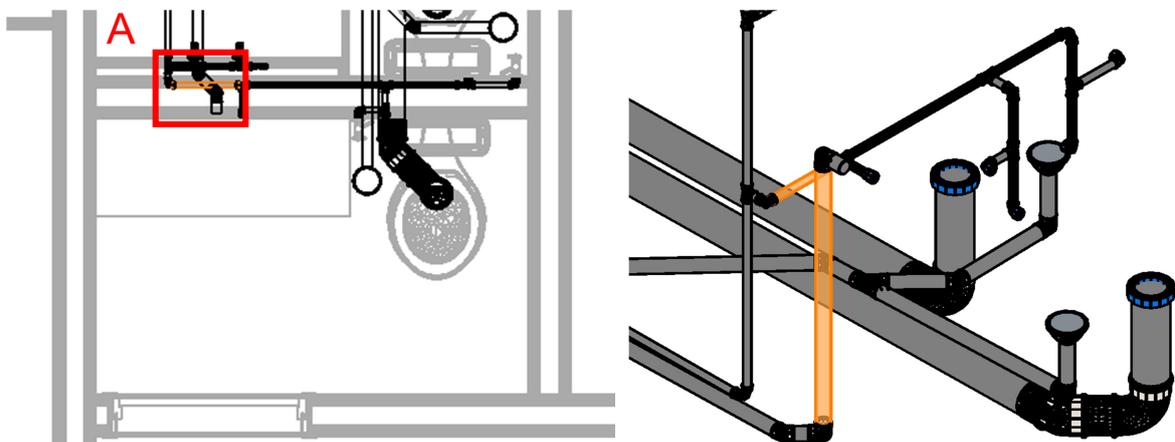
Planta baixa do pavimento térreo hidráulico com o sanitário
